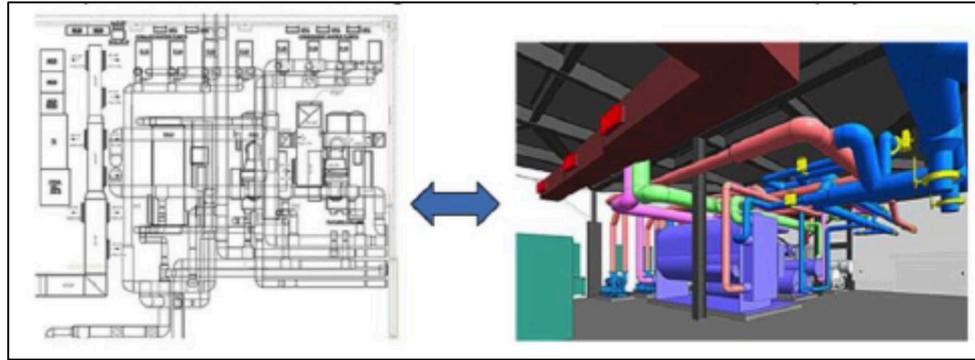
Tahapan Dimensi Konstruksi BIM
